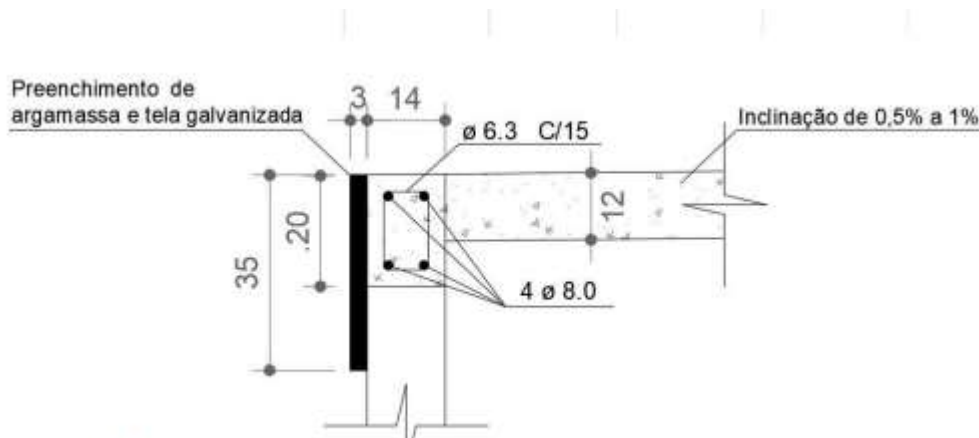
Detalhamento da reconstrução da laje de tampa do reservatório. (Fonte: Próprio autor)
